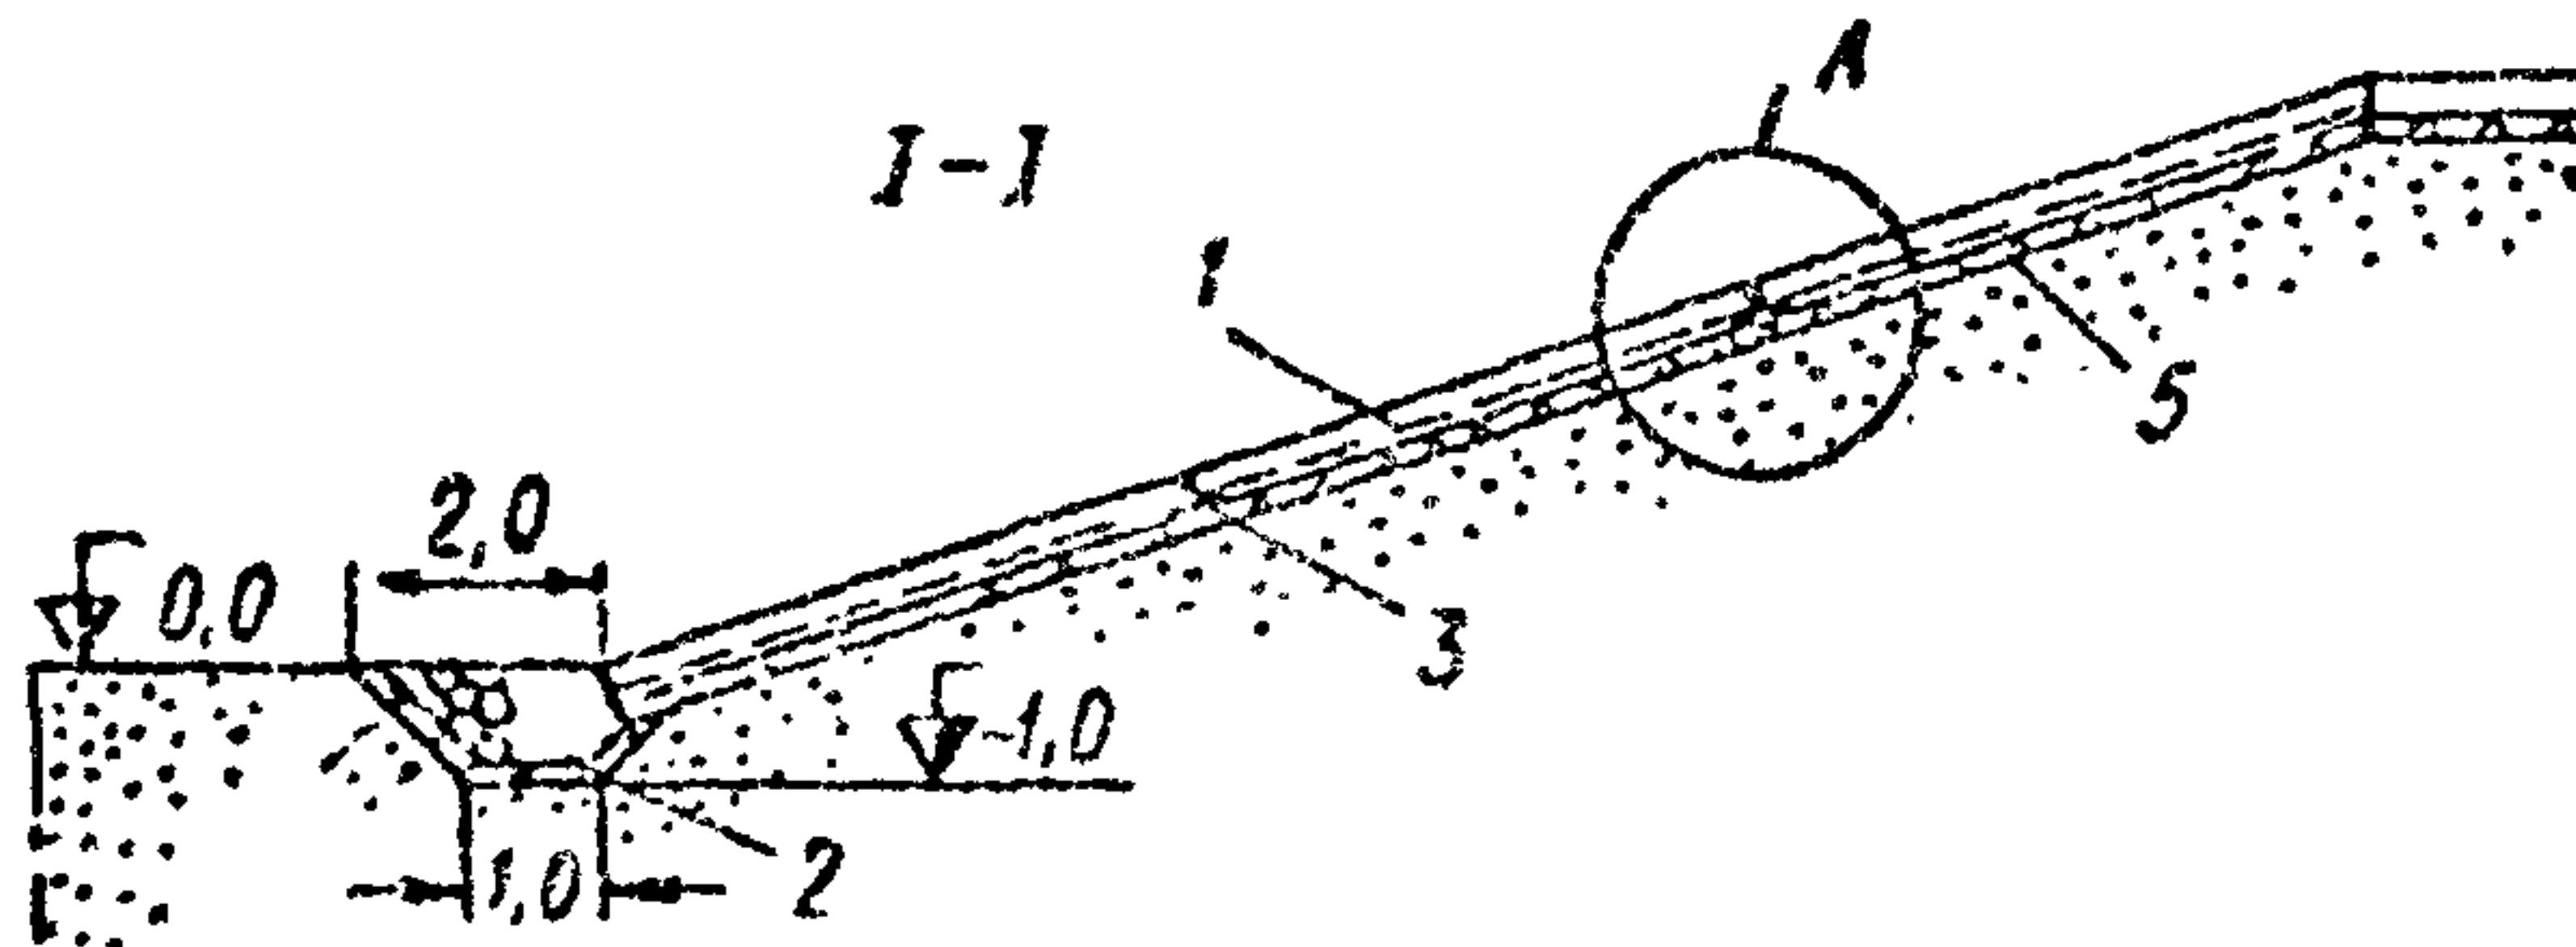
Схема крепления монолитными железобетонными плитами:
